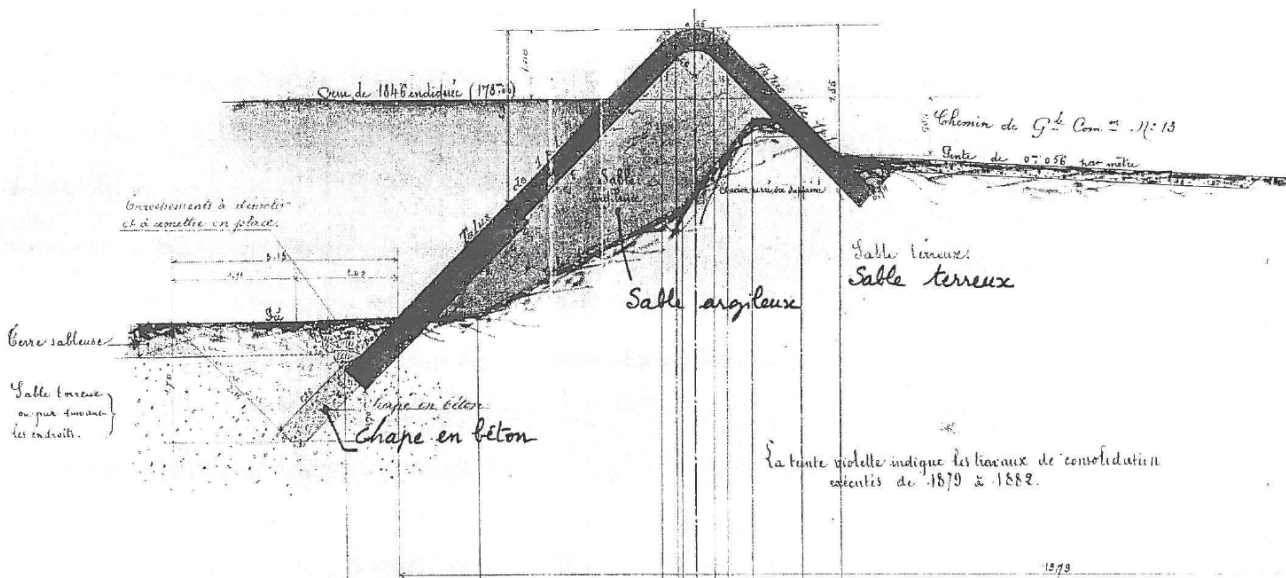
Profil type de la levée de Sermoise 1^{re} section avant et après travaux d'exhaussement et de consolidation, exécutés entre 1879 et 1882 – Source : Étude SOGREAH 2002, volet historique
